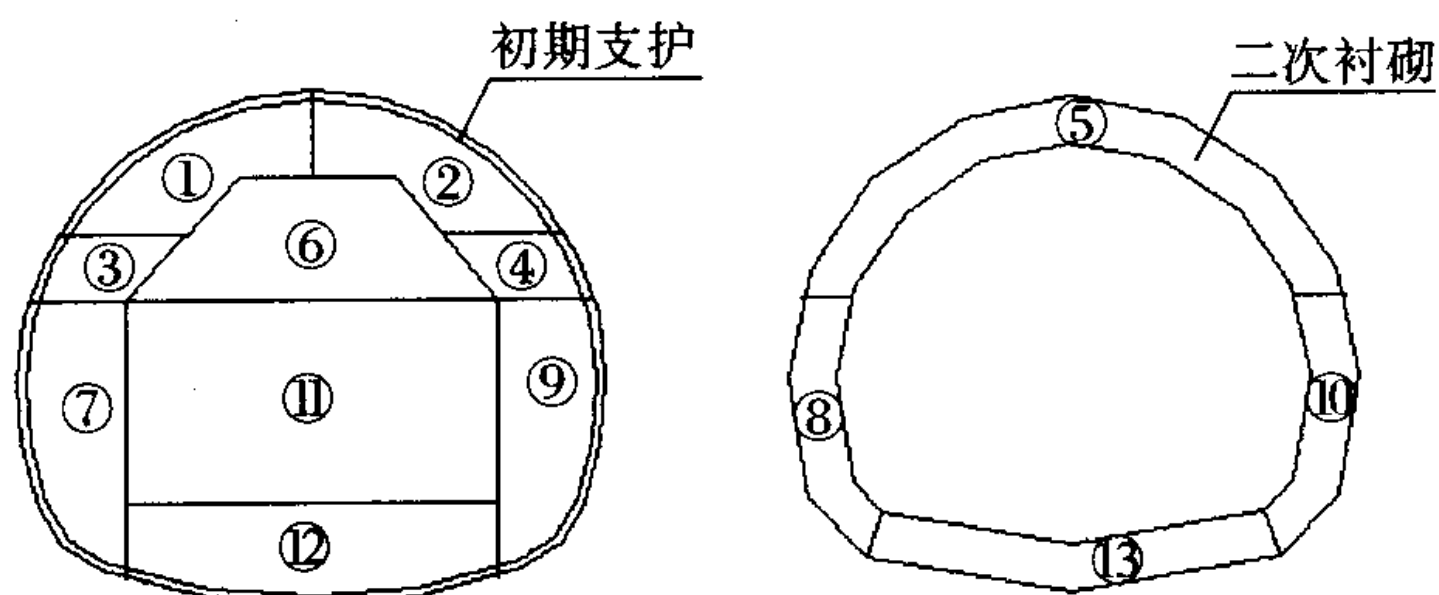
开挖和衬砌施工顺序示意(序号为施工先后顺序)
